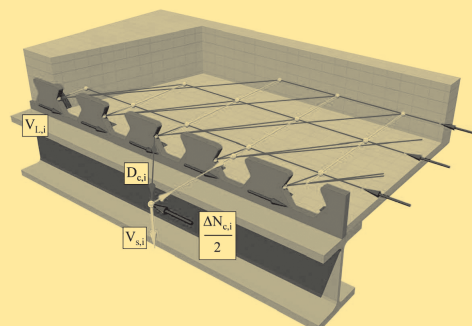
System zur Bestimm. der Zug- und Druckstreben im Betongurt
